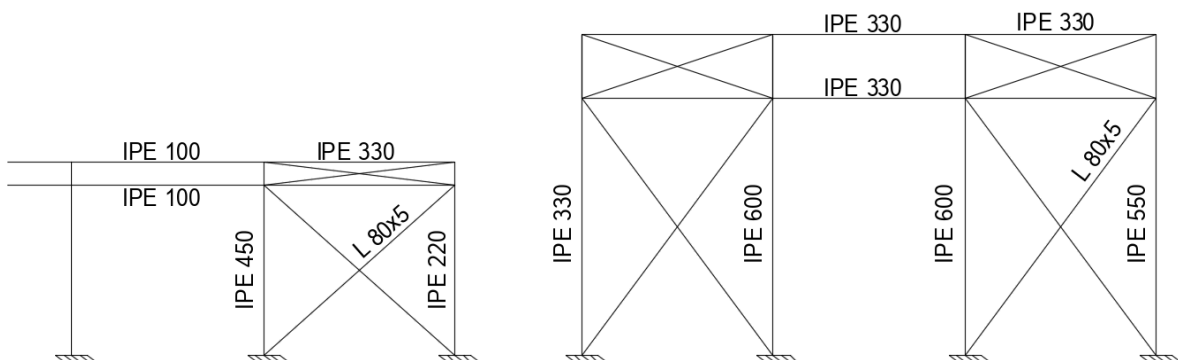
Vigas perimetrales para la zona baja (izquierda) y la alta (derecha)
